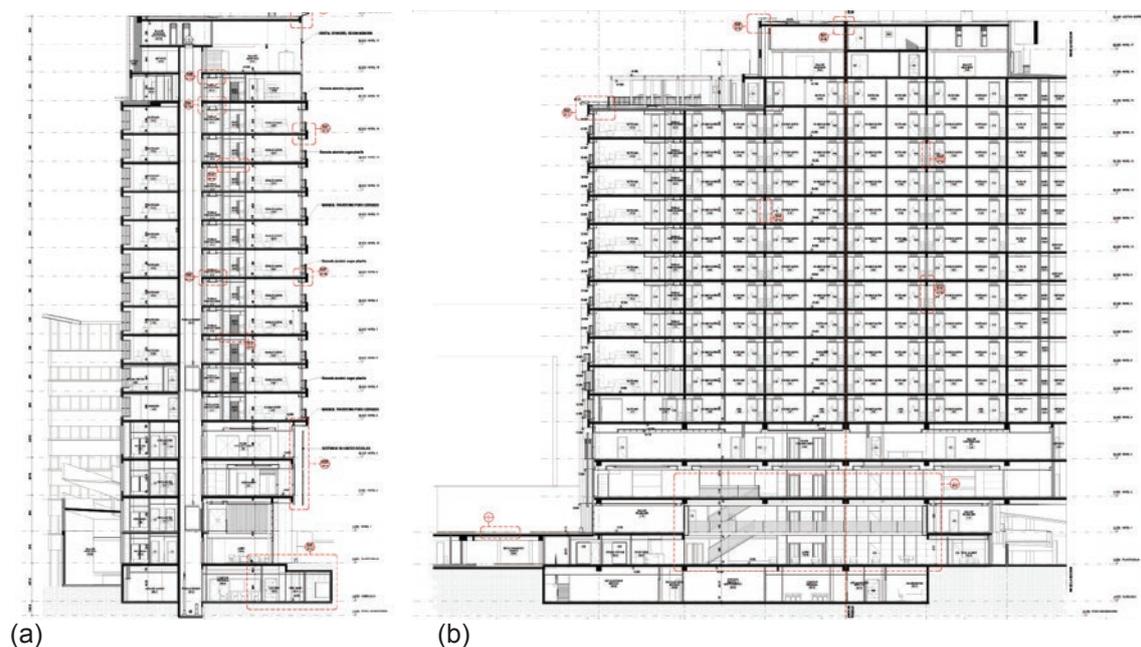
(a) Corte transversal. (b) Corte longitudinal. Fuente: archivo estudio GP.
